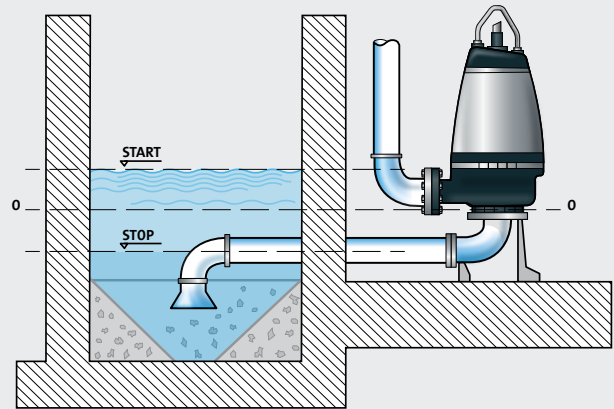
Tauchbare vertikale Trockeninstallation mit Standfuß zur Befestigung am Fundament
